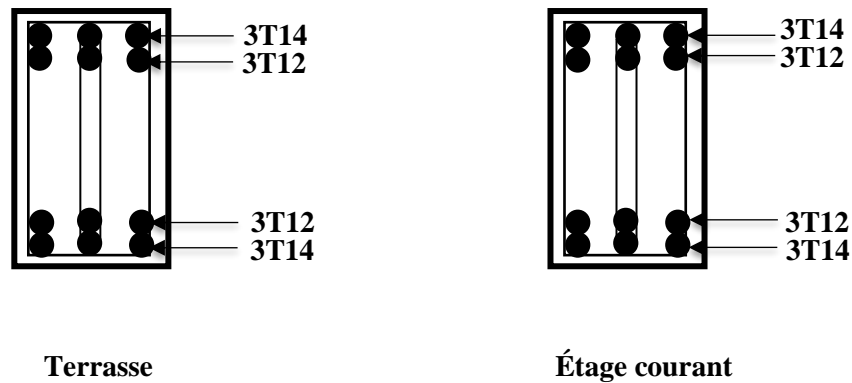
Dessin de ferrailage des sections des poutres principales
